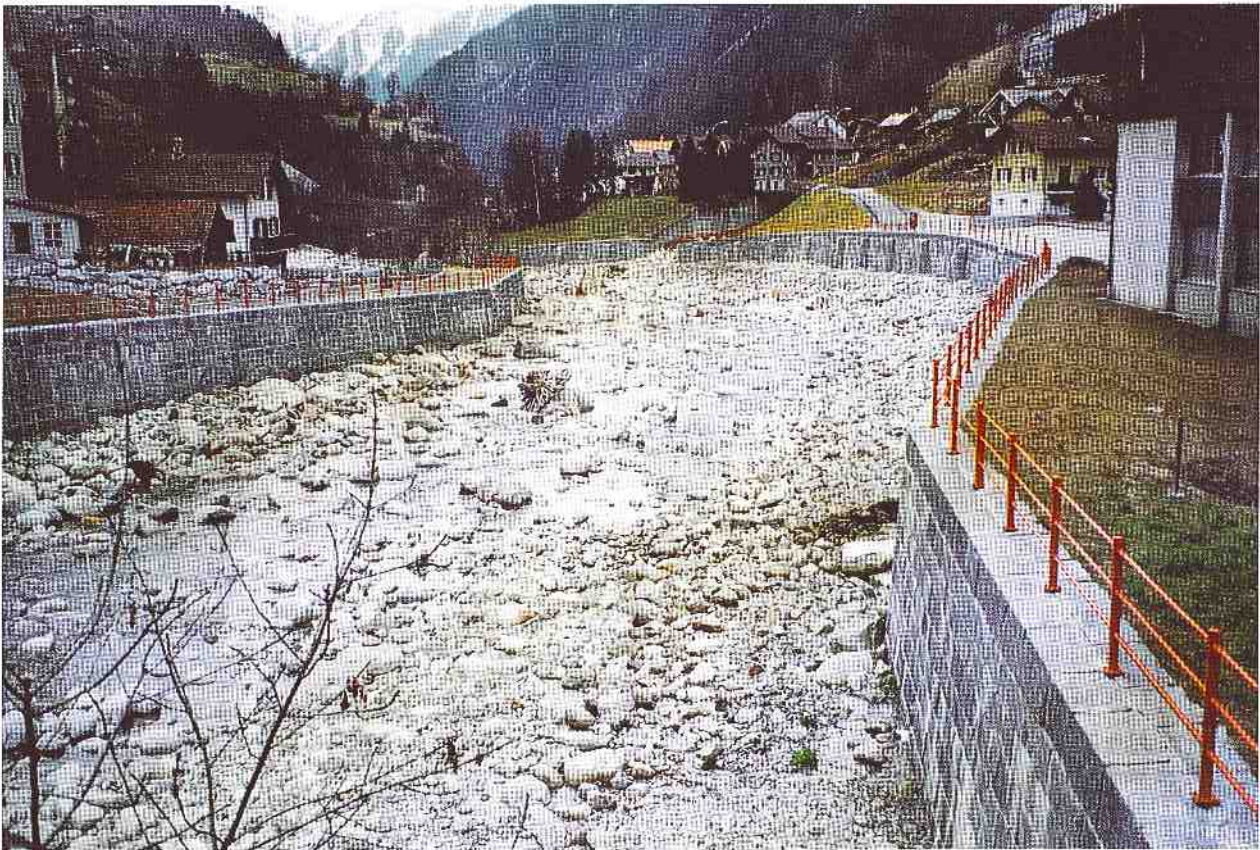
Ufermauer vor dem Kreisschulhaus bis zur Einmündung des Steintales.
